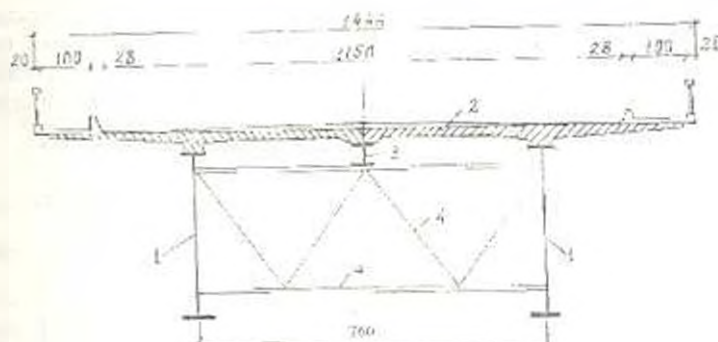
Поперечное сечение моста: 1 - главные балки сплошного сечения; 2 - железобетонная плита проезжей части; 3 - продольная балка; 4 - поперечные связи
